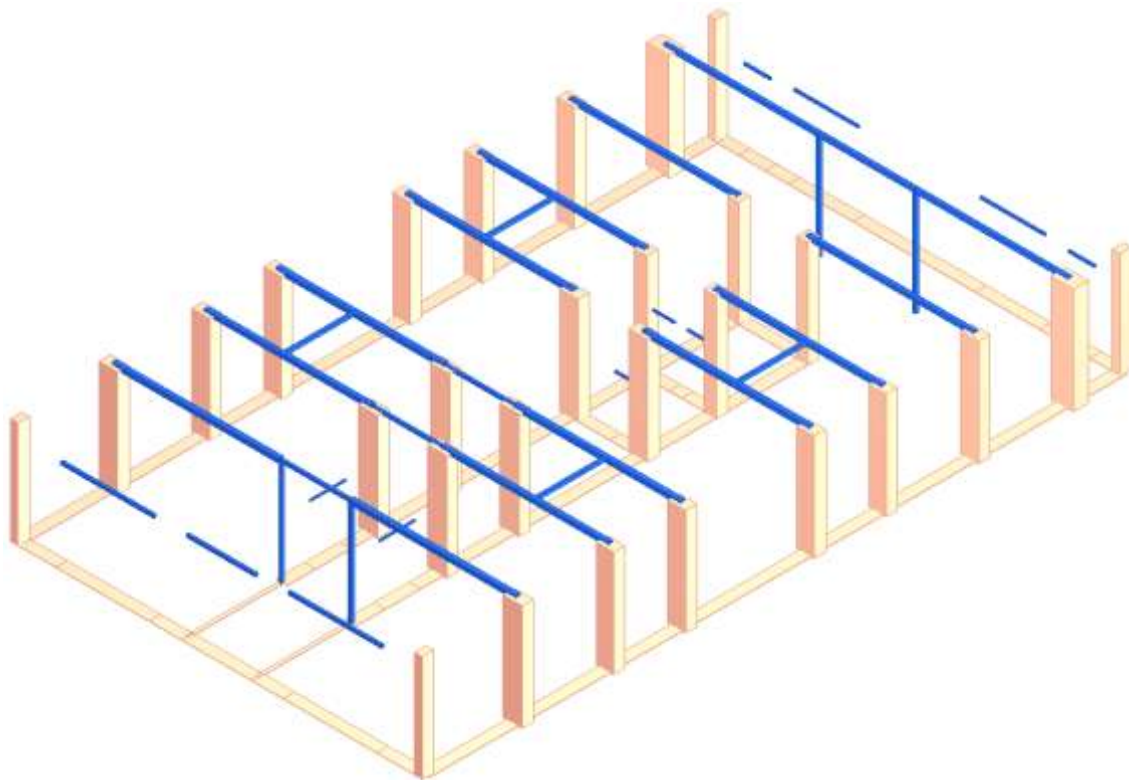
Columnas y dinteles (misma disposición que en plantas superiores) de la planta baja del edificio
